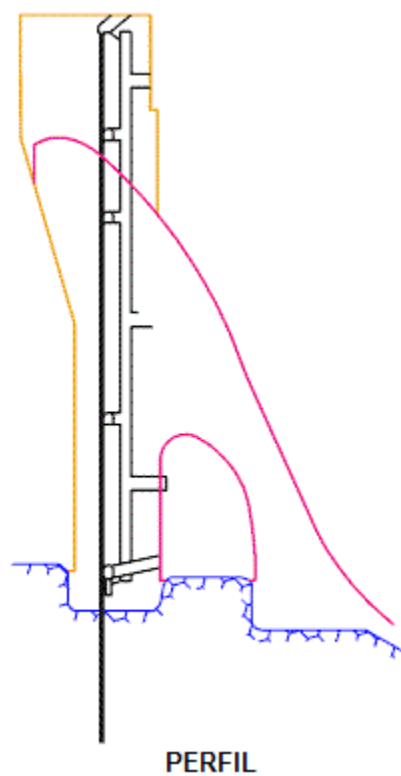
Barragem de Bemposta – Perfil [4]
